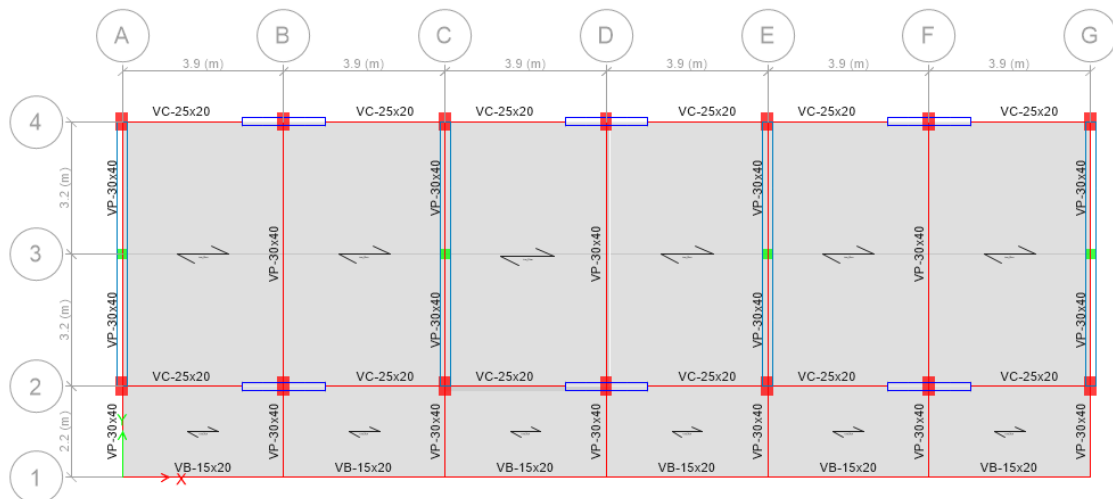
Vista en planta del pabellón 4 con placas de concreto armado.
